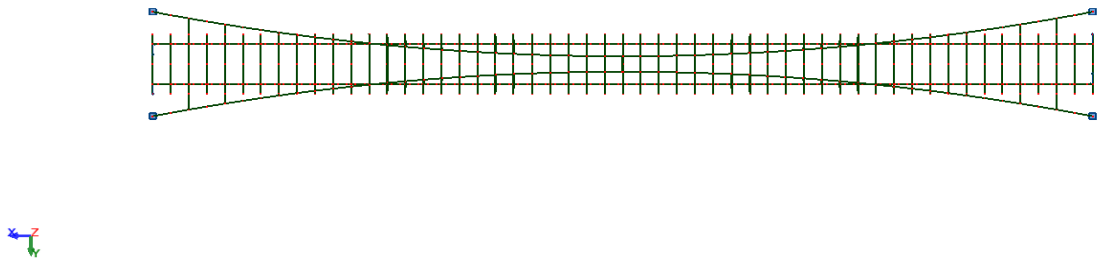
Planta do modelo de cálculo (plano XOY)
